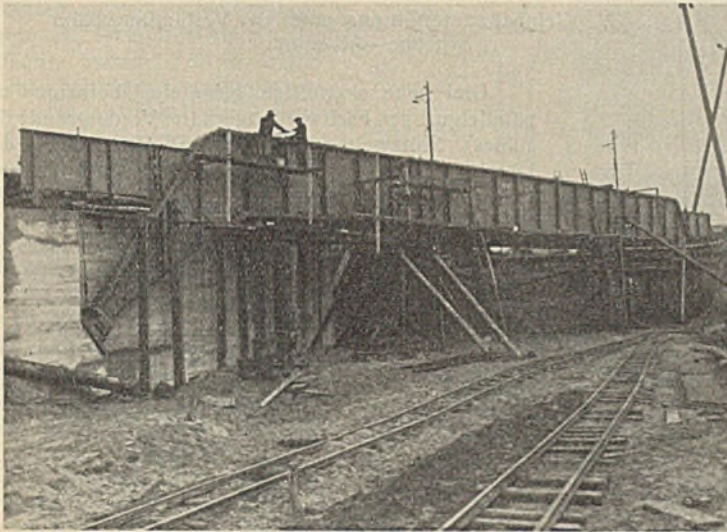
Unterführung der Provinzialstraße unter der Strecke Köln—Düsseldorf.
